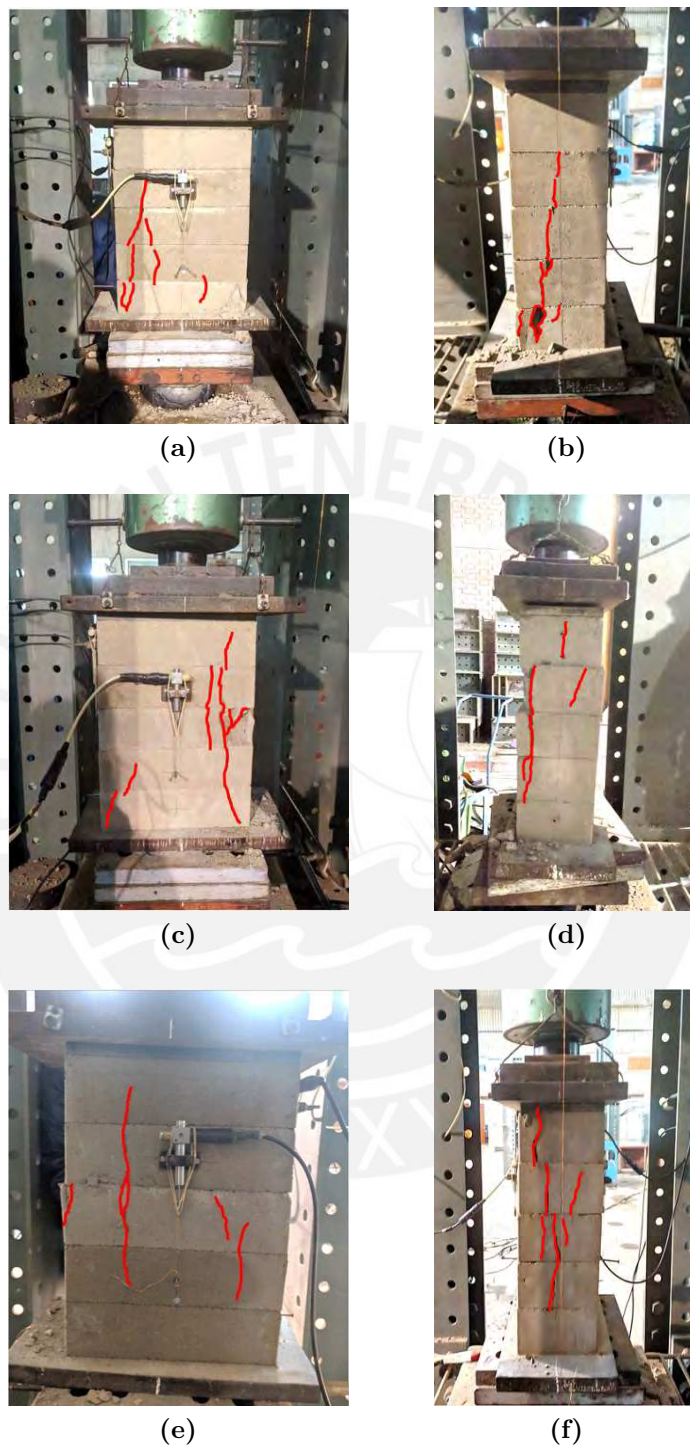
Patrones de falla del ensayo de compresión en pilas PCL: (a-c-e) fallas generadas en una de las caras longitudinales y (b-d-f) fallas generadas en la cara transversal.
